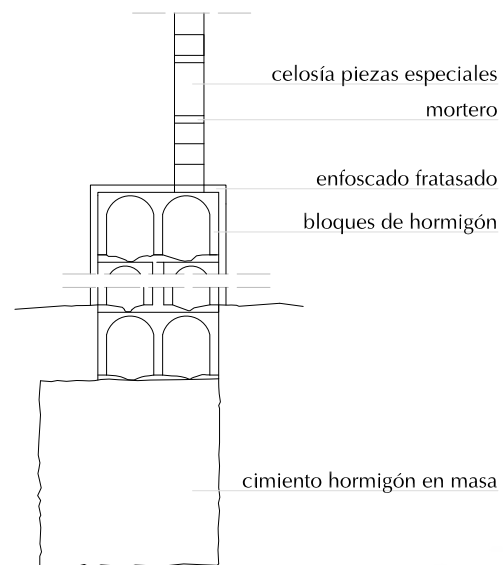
Detalle constructivo de cerramiento de secadero de bloque de hormigón
